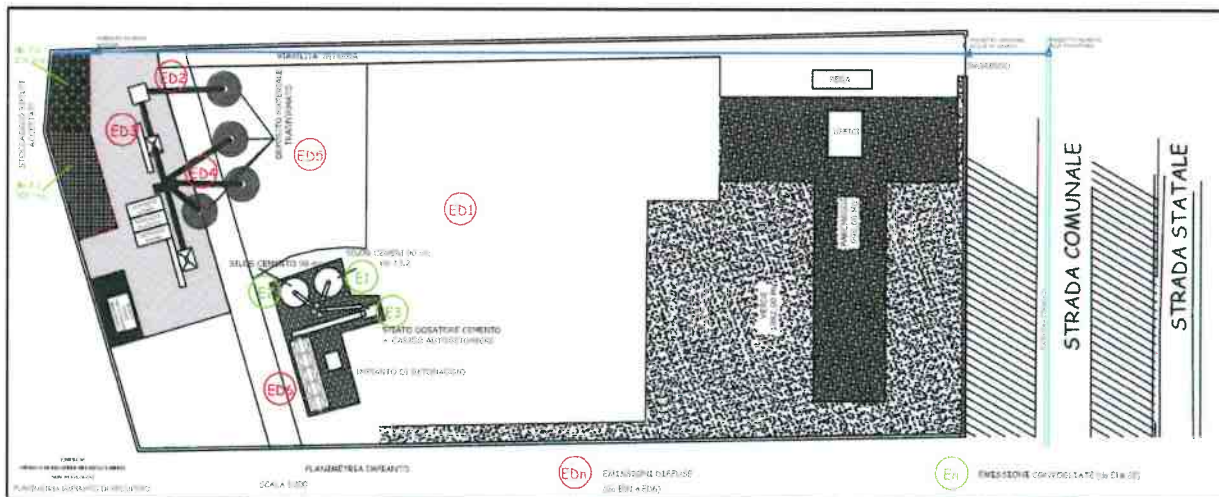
Layout impianto con suddivisione delle aree ed indicazione dei punti di emissione (dall'elaborato "Progetto preliminare").
